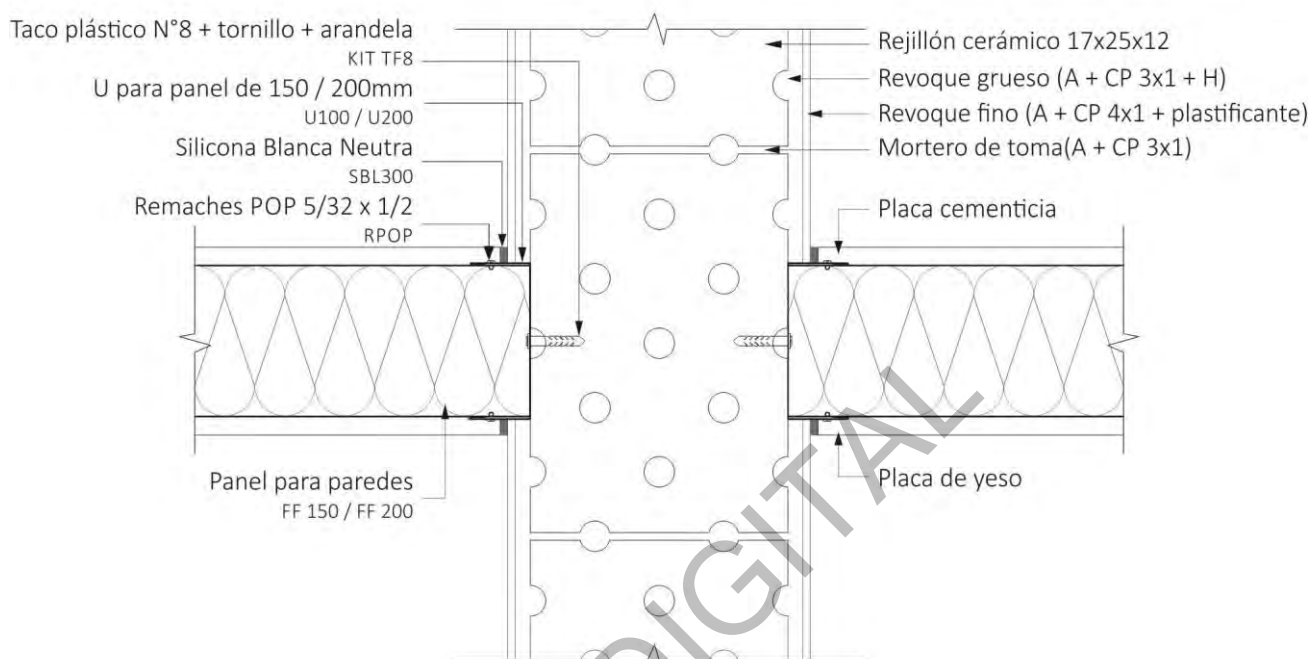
Detalle esquemático de la unión con muro de mampostería. Los paneles verticales serán FF150 o FF200, según proyecto.
